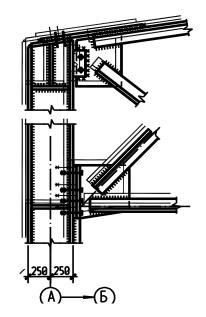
Узел сопряжения фермы с колонной
